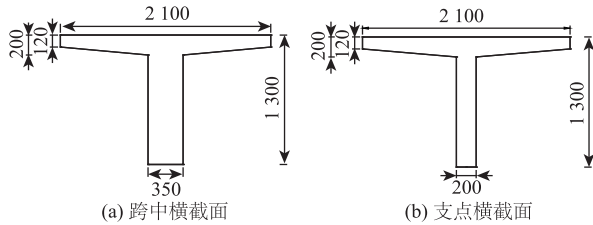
T 梁跨中横截面及支点横截面构造图 (单位: mm)
